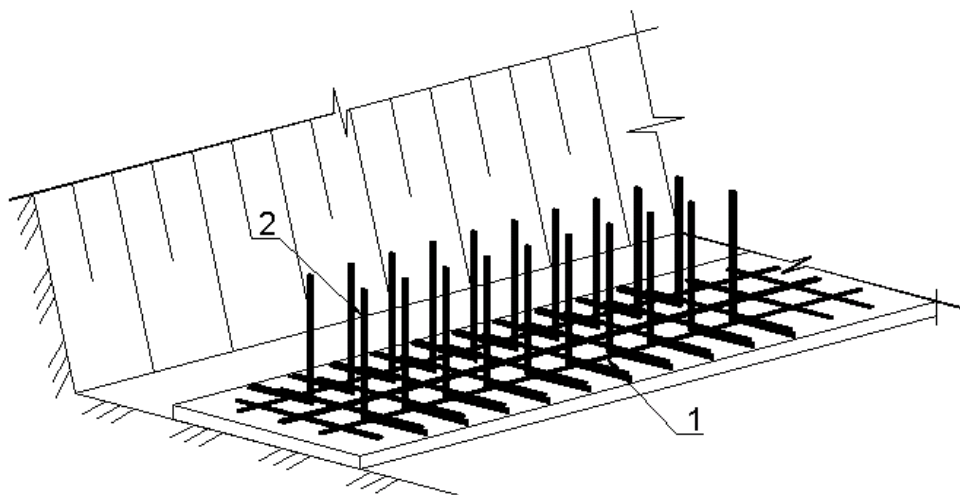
Установка вертикальных арматурных стержней. 1 – нижняя сетка армирования, 2 – гнутые вертикальные арматурные стержни.
